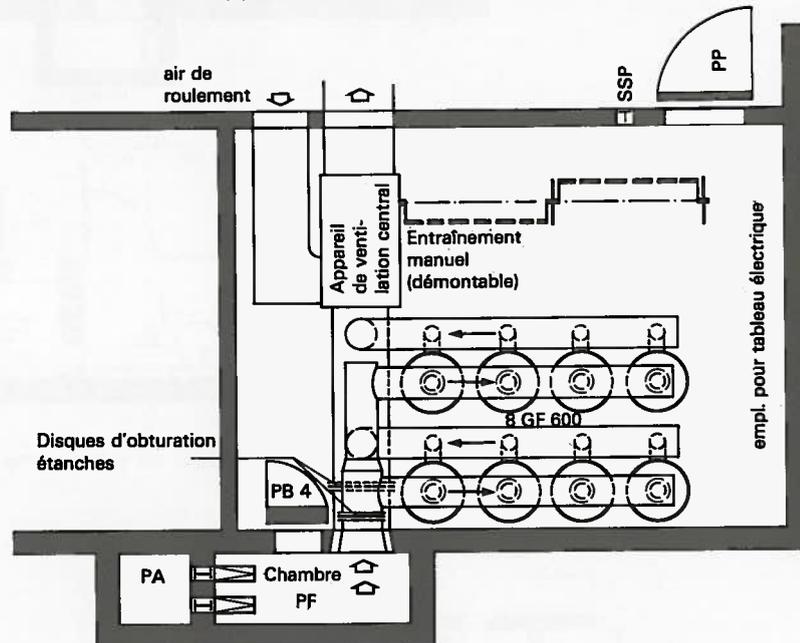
Exemple d'un local de ventilation avec appareil de ventilation central et 8 GF 600 (plan)
